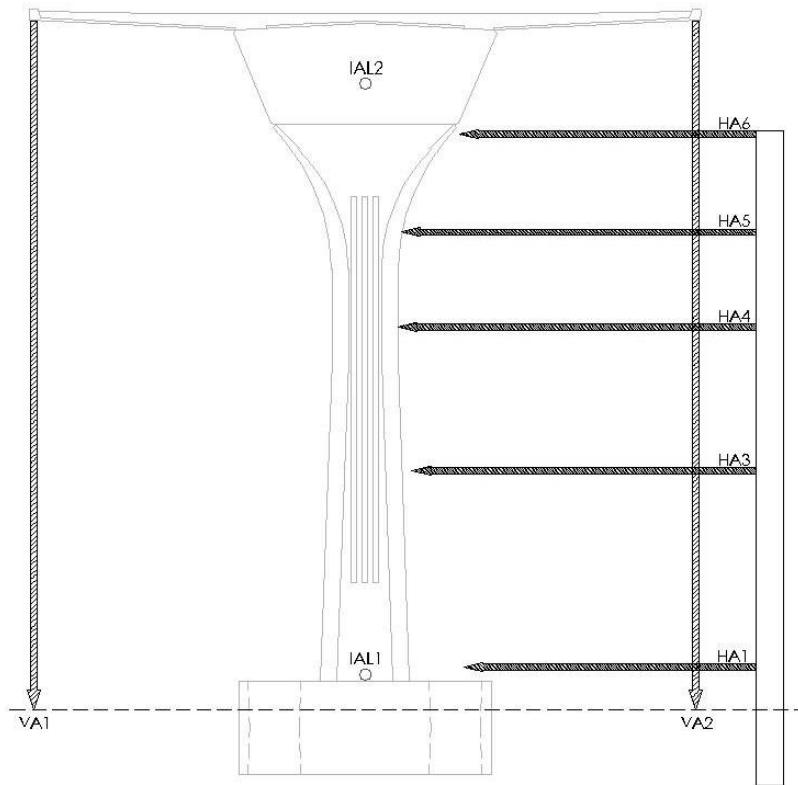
Posición de la instrumentación colocada en la columna A240
